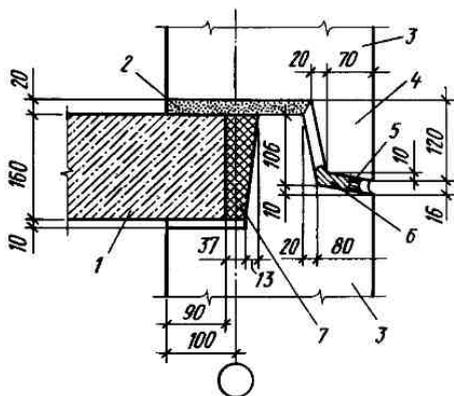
Конструкция горизонтального стыка однослойных стеновых панелей:
